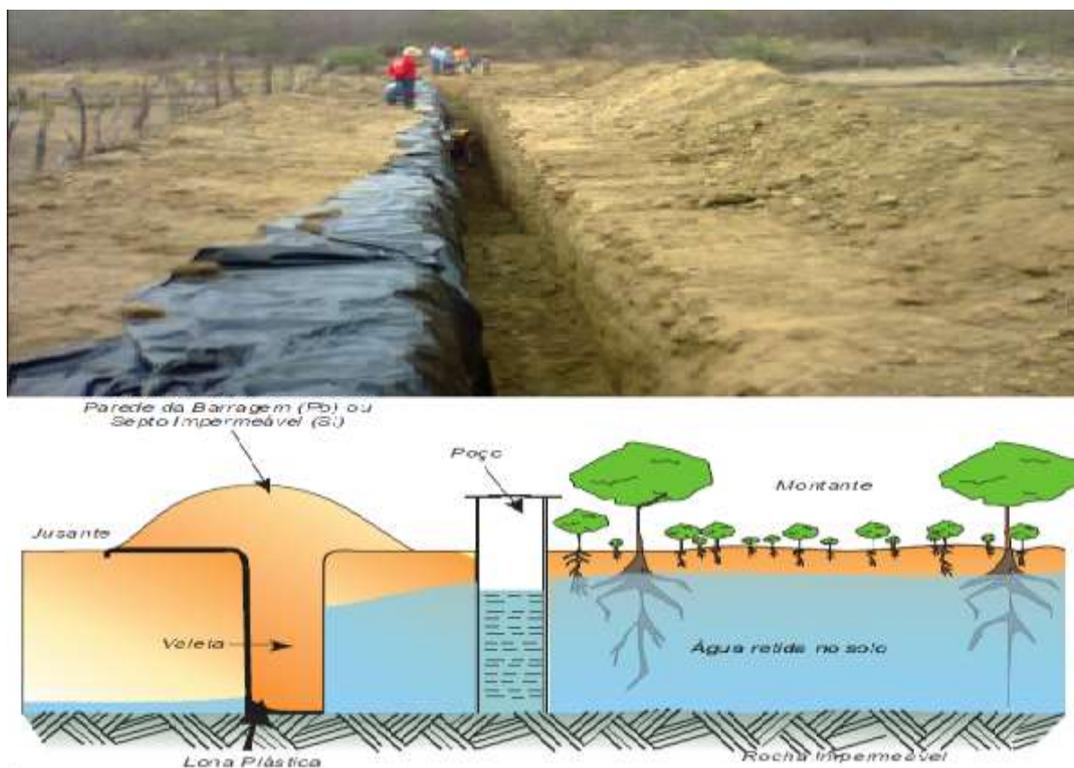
Imagens da construção e funcionamento de uma barragem subterrânea
